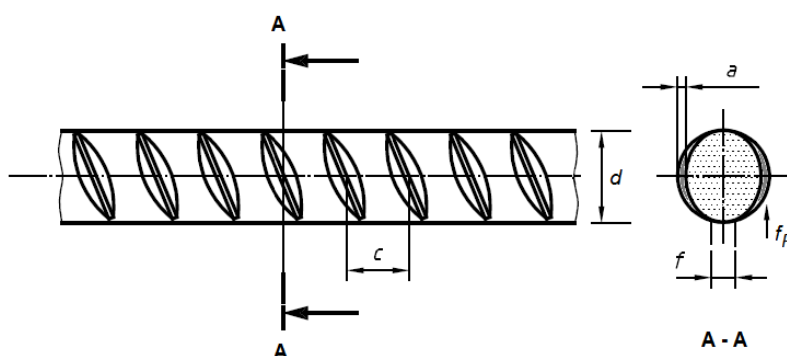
Parâmetros do perfil nervurado dos varões de aço para betão armado (adaptado de [74]).
